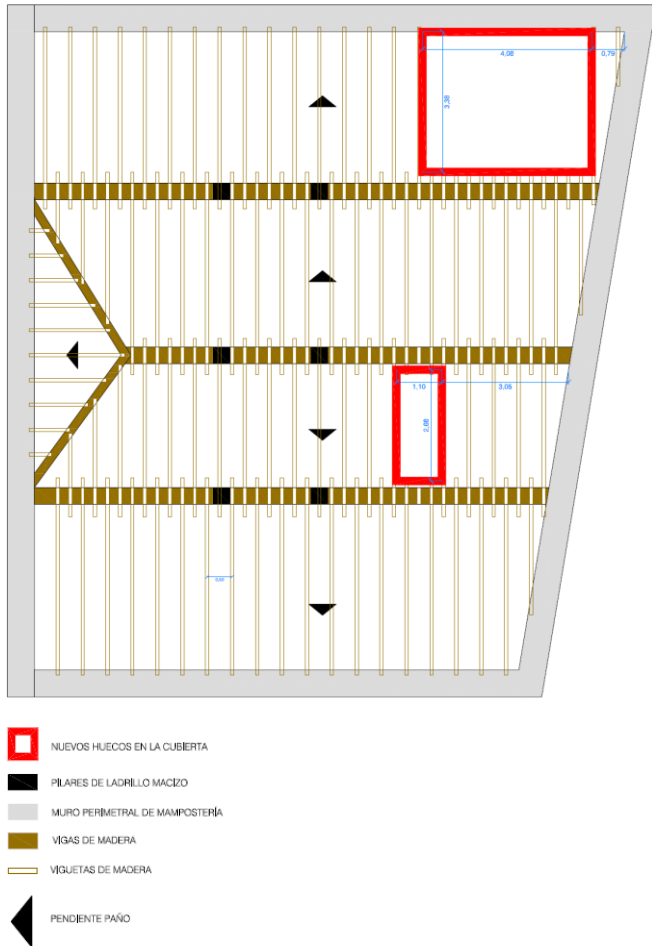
Esquema estructural de la cubierta. 2023. Fuente: propia.
